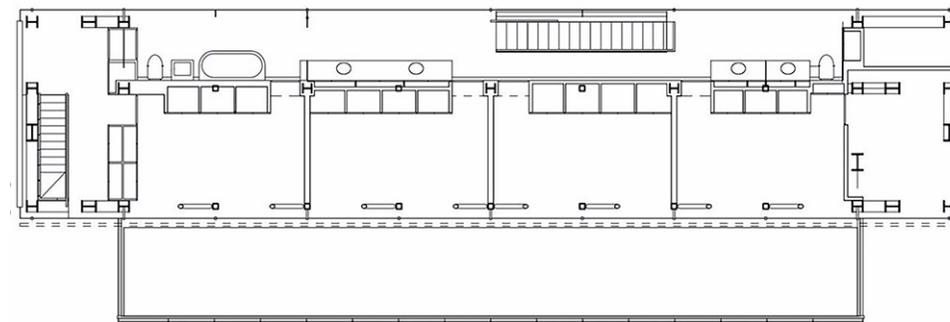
Picture Window House - Planta Alta. Elaboración: Shigeru Ban Architects
